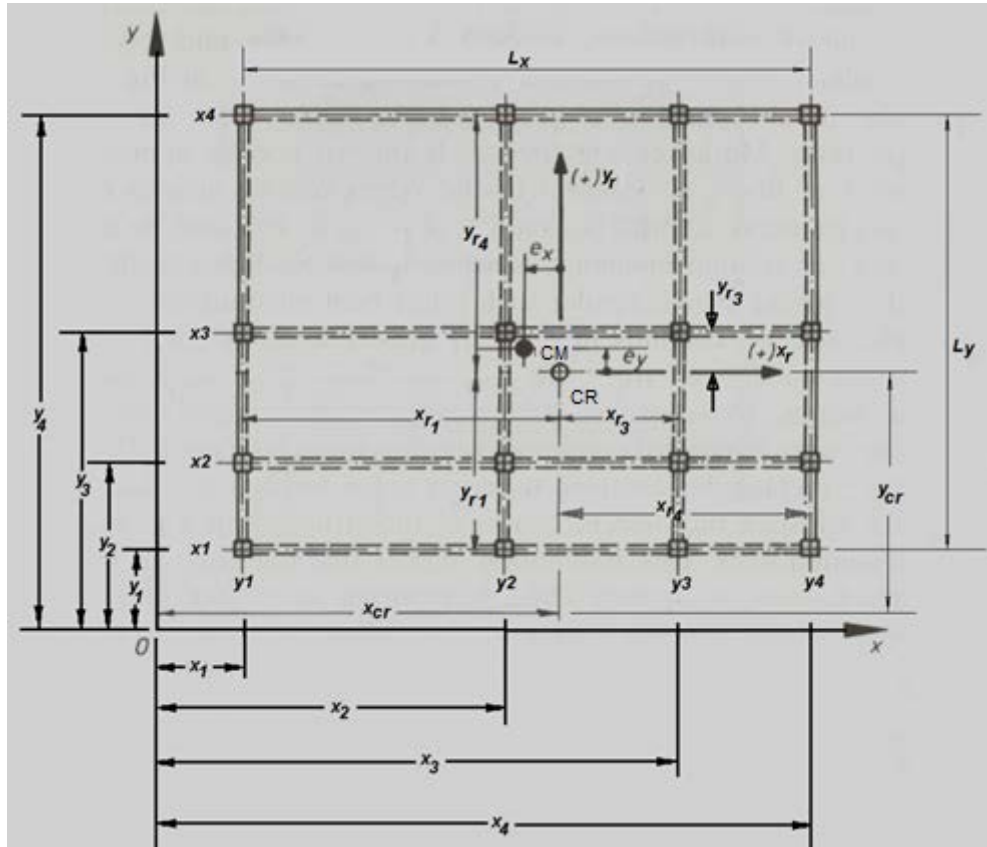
Planta andar tipo. [Paulay, 1992 adaptado]
